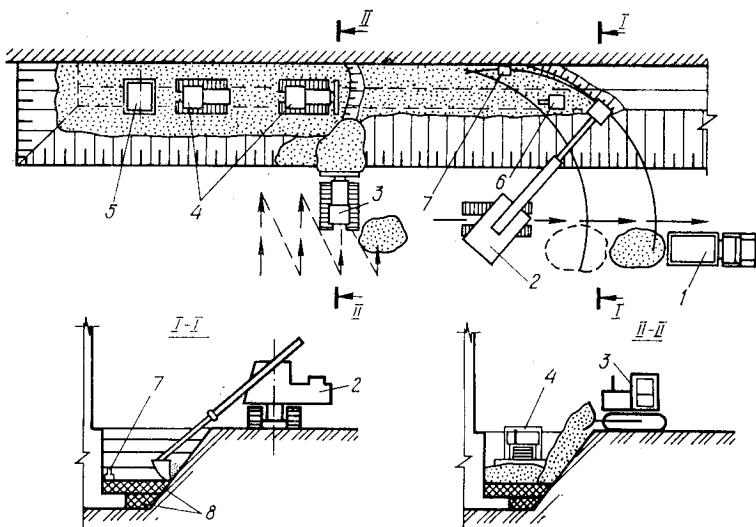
Схема уплотнения грунта обратных засыпок в узких и глубоких пазах фундамента:
